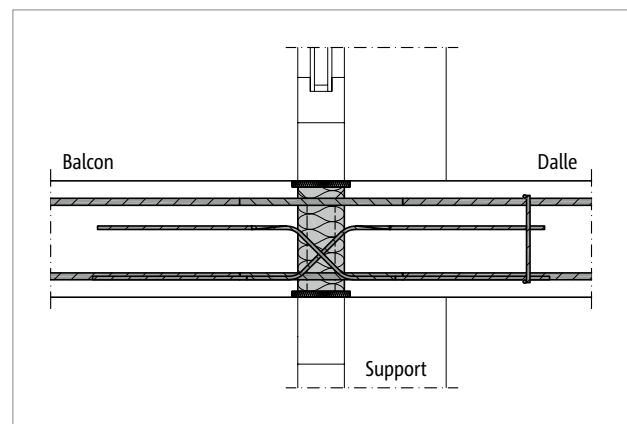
Schöck Isokorb® T Type D : Coupe de montage ; plancher plat
